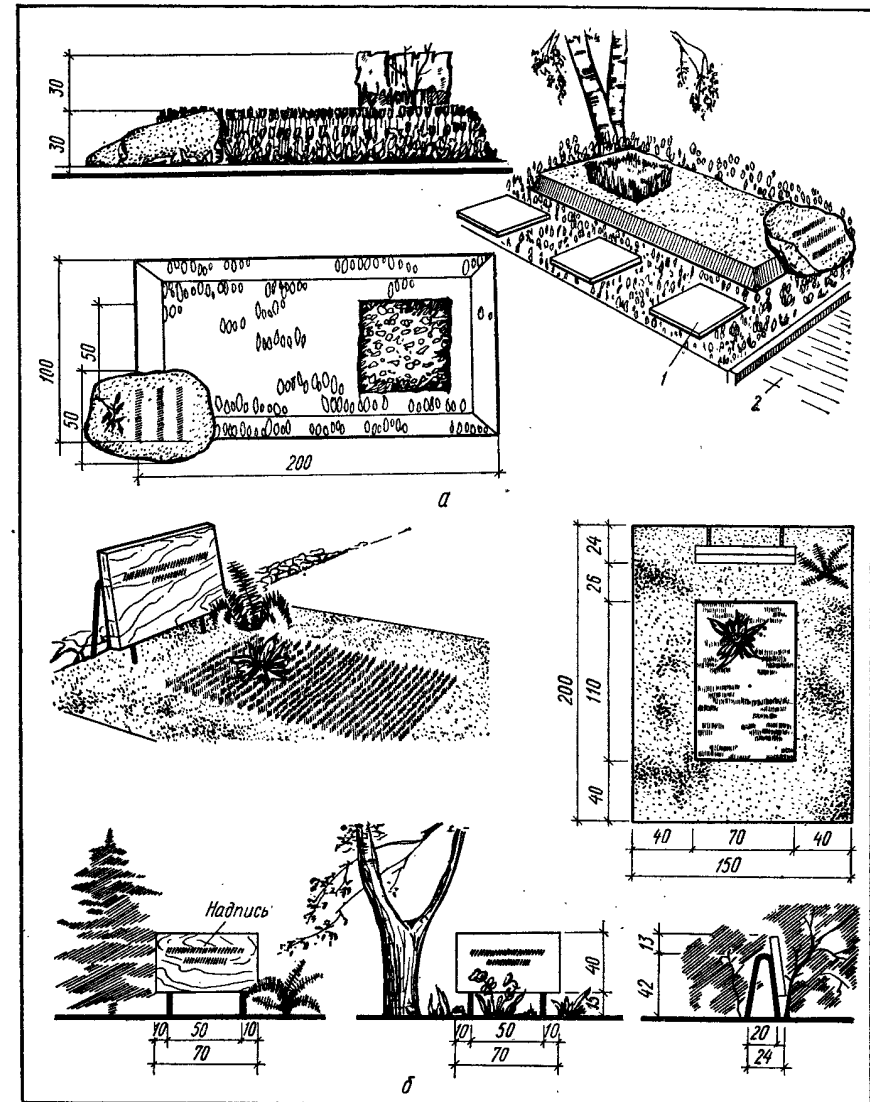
Типы и размеры благоустройства мест захоронения (фасад, план и общий вид):
